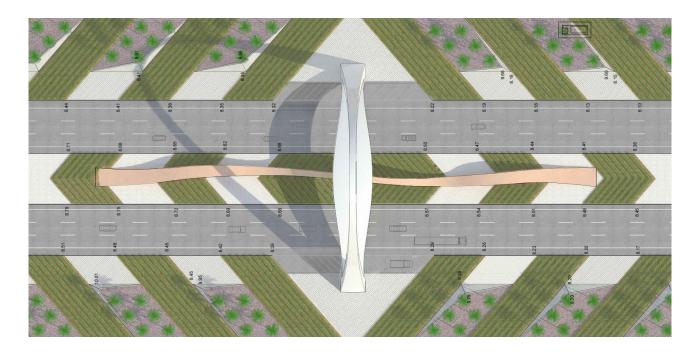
Puerta de entrada a Jeddah en dirección Medina. Planta
